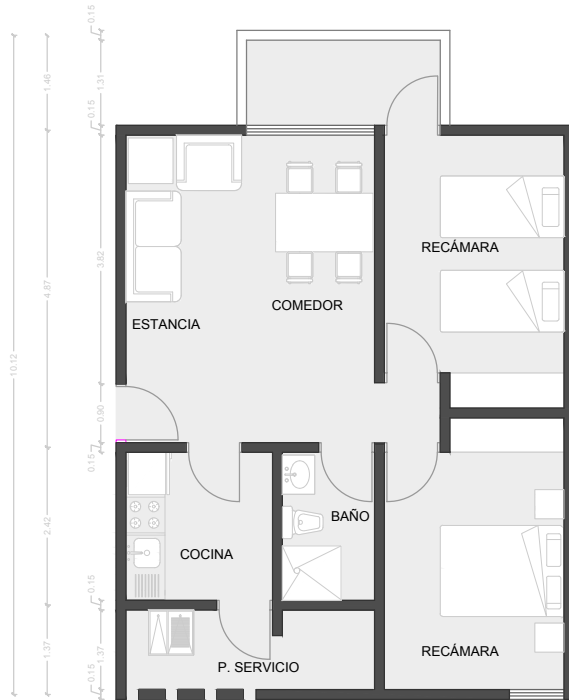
Planta arquitectónica original departamento tipo A-01 Fuente: Elaboración propia
